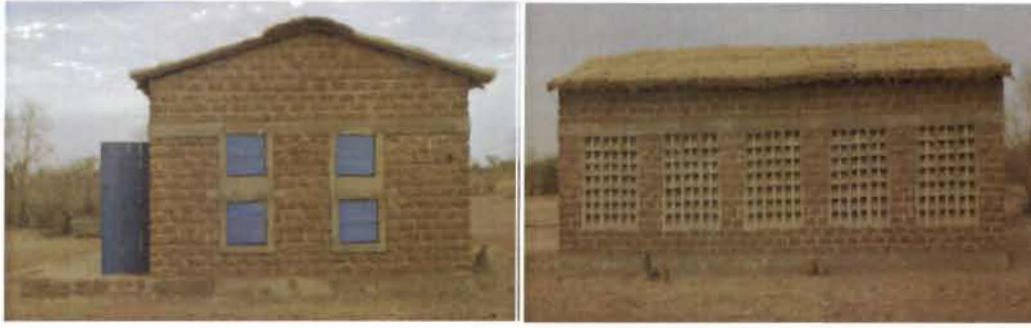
Silos modernes de conservation avec toiture en paille (Dédougou)
